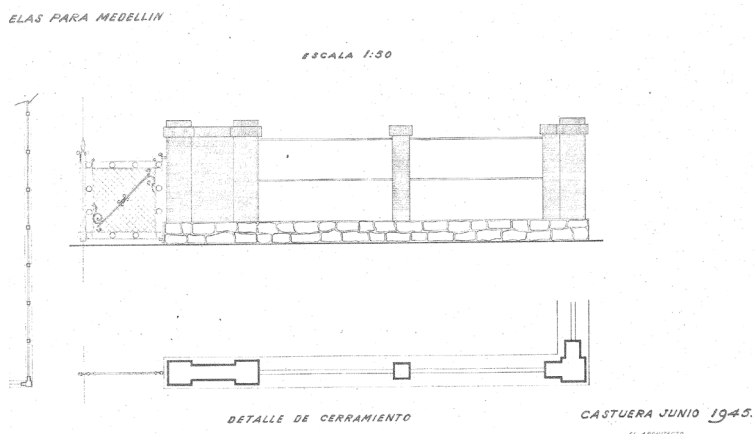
Plano de “Reconstrucción y Reforma”. Planta Proyecto de Construcción de Escuelas para Medellín (Badajoz)
